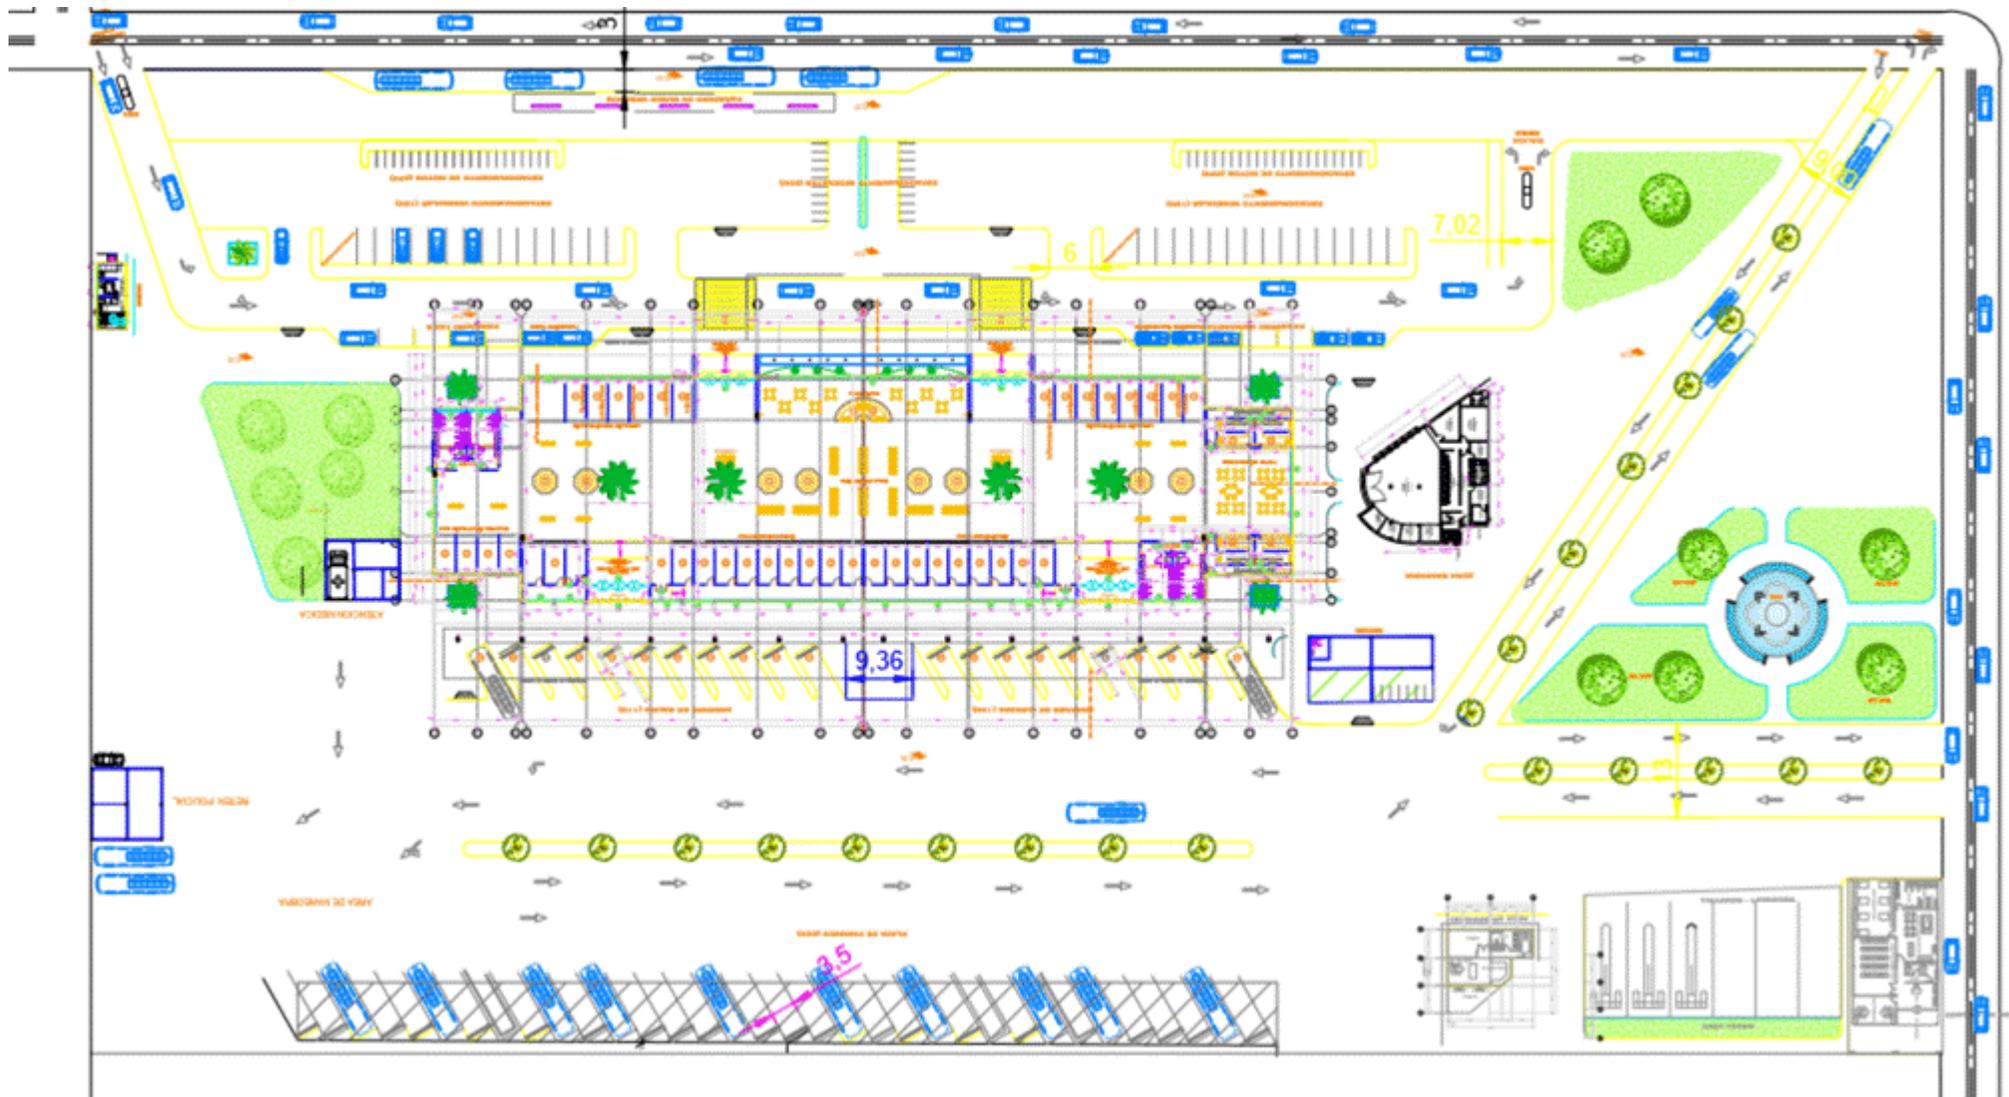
Vista en planta de terminal terrestre para la Joya de los Sachas
